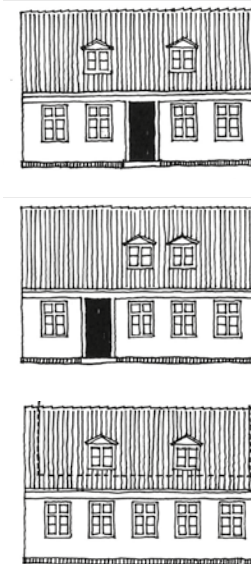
Traditionel facadedisponering, placering af vinduer og kviste.
